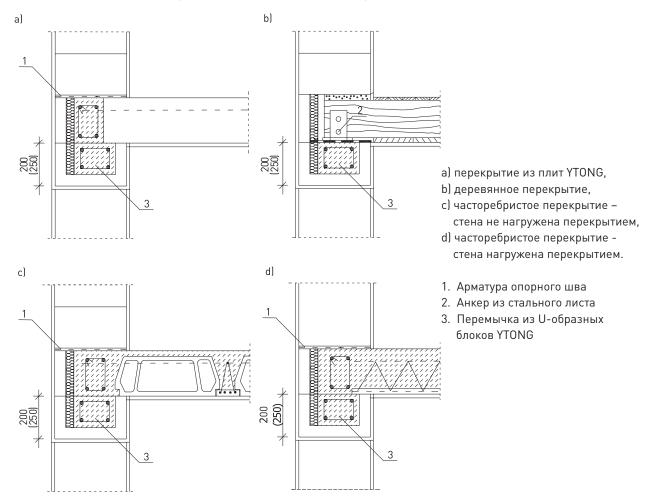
Устройство перемычки в наружной стене в зависимости от вида перекрытия
